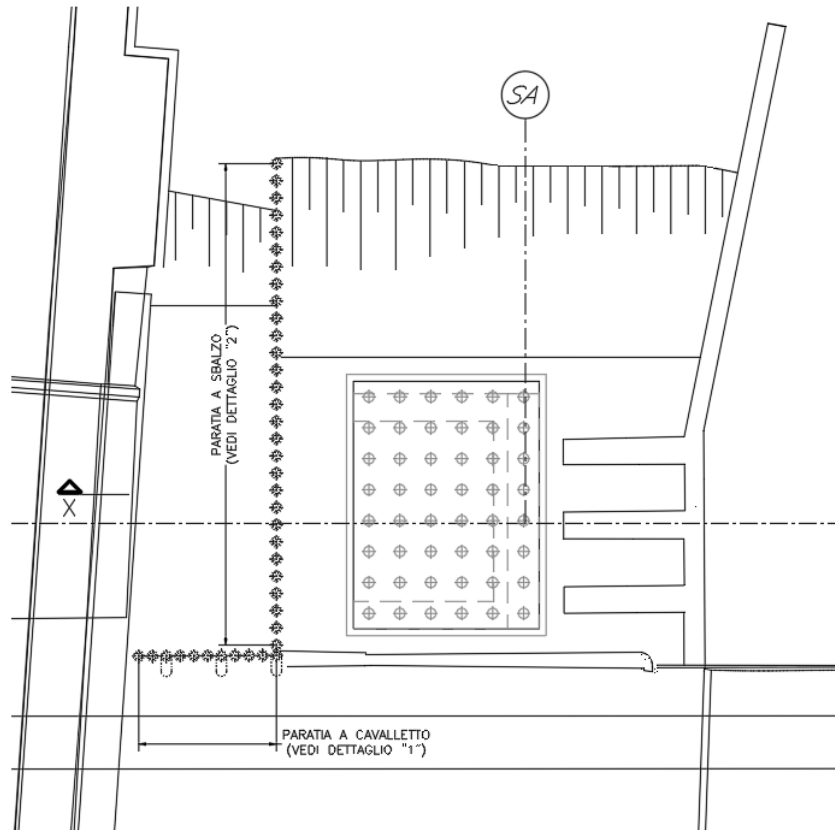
Pianta Opere Provvisionali Spalla A
